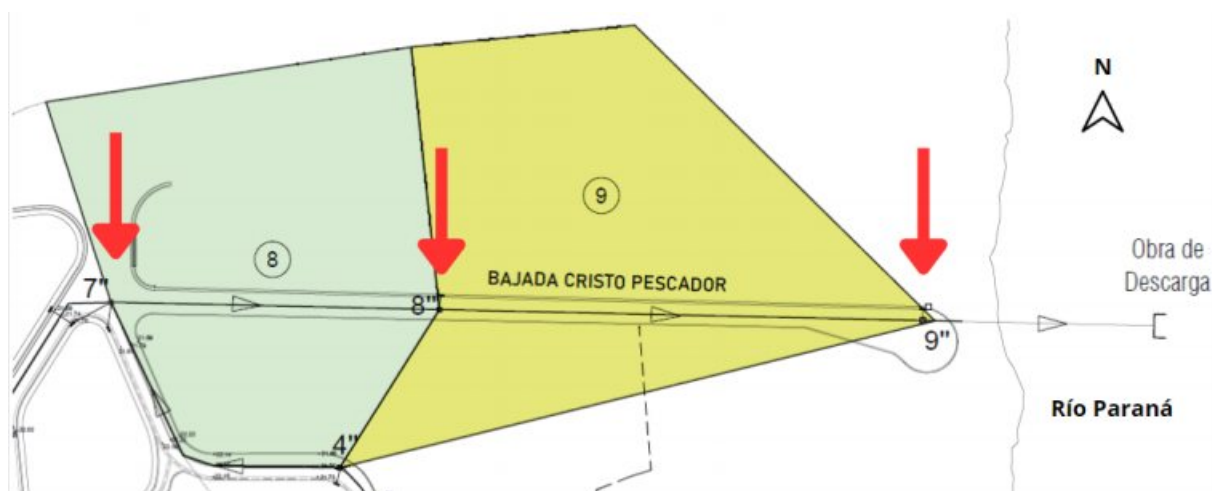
Primer planteo ubicación de cámaras de caída; esquema en planta. Fuente: Elaboración propia.
